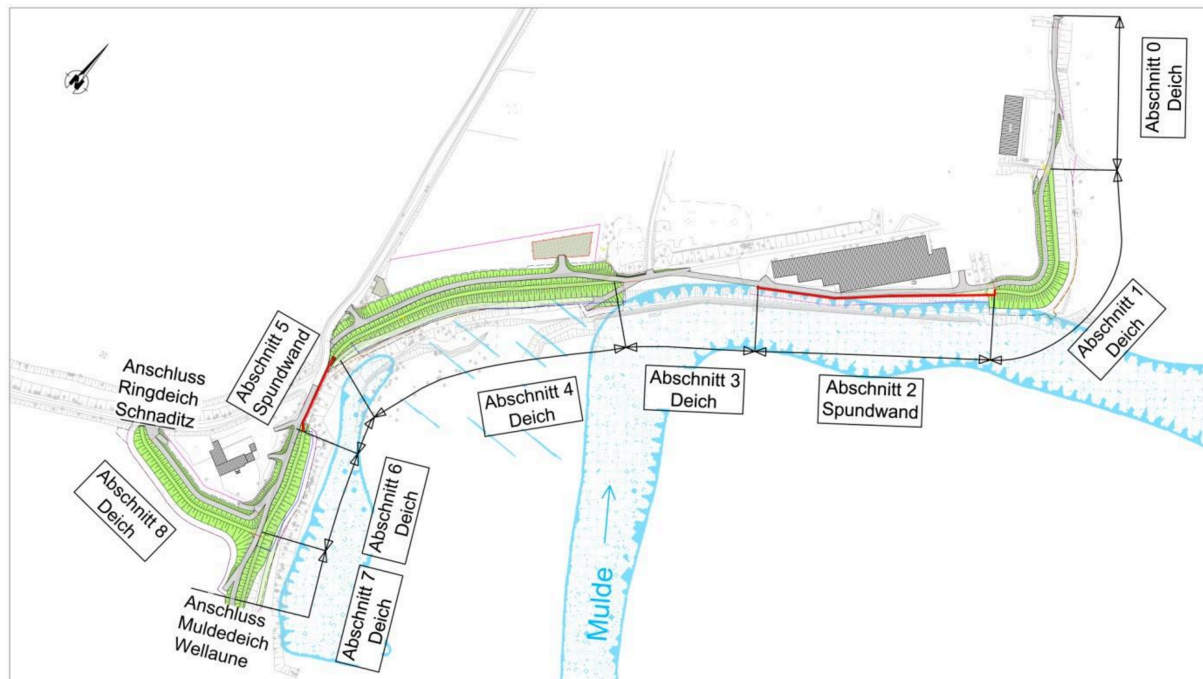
Übersichtslageplan Muldedeich Profiroll
